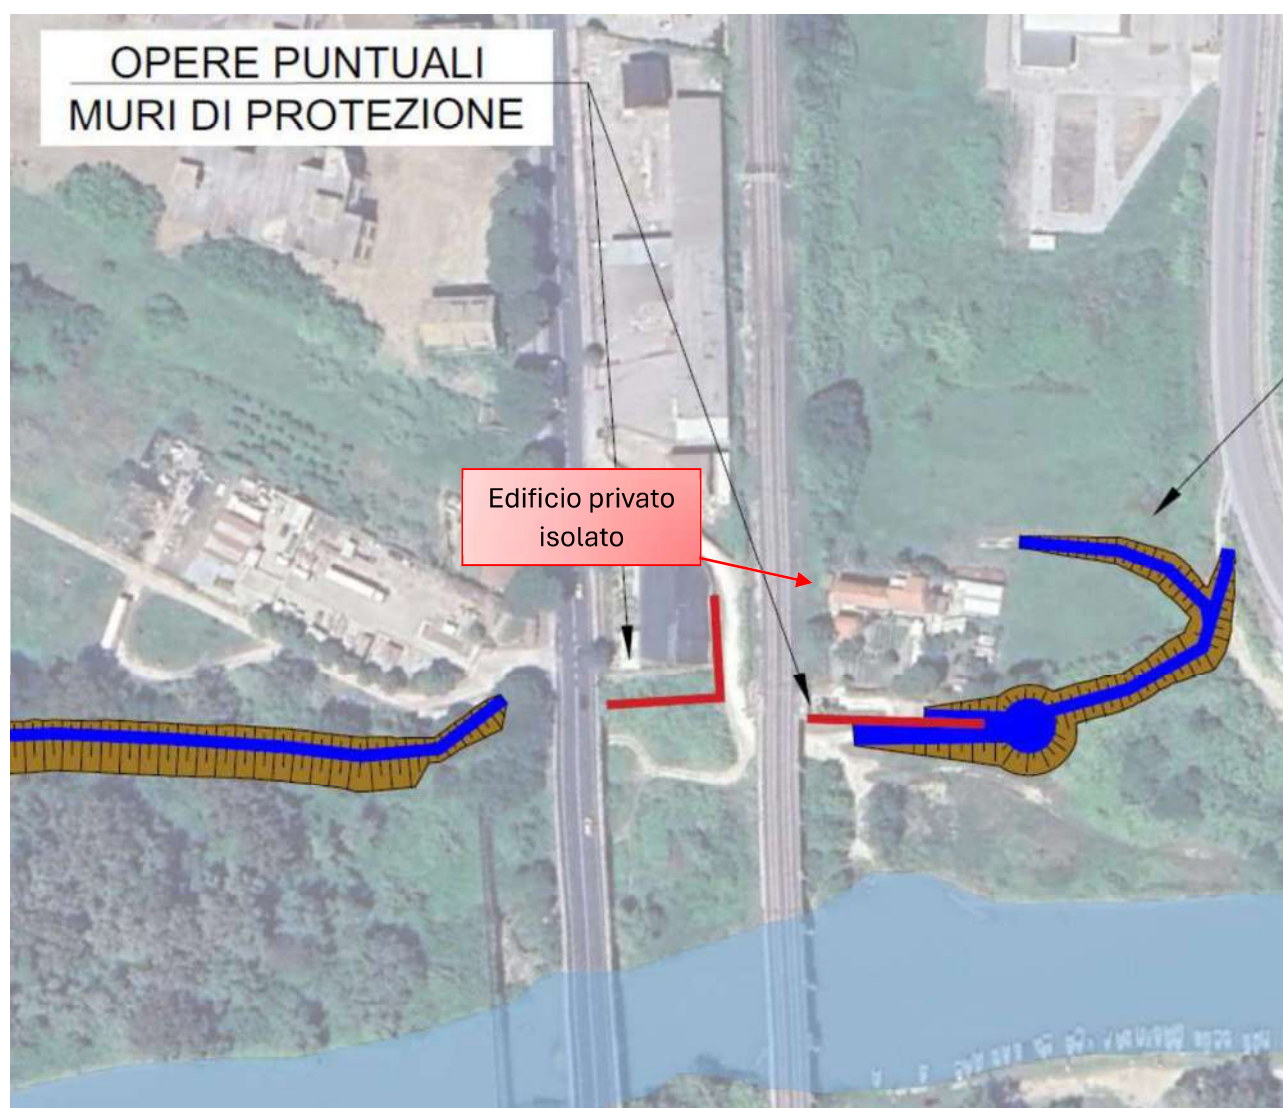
Arginature di progetto con accesso all'abitazione isolata
